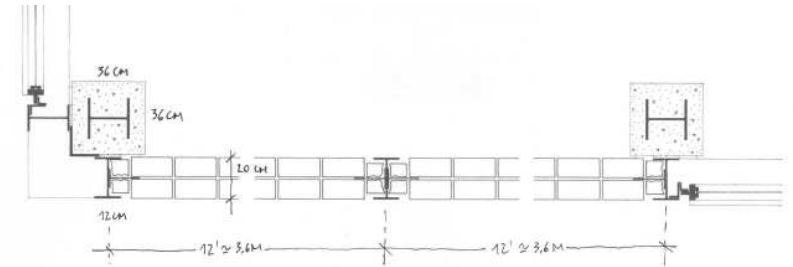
Whisnick Hall. Subestructura en fachada sin función estructural.
